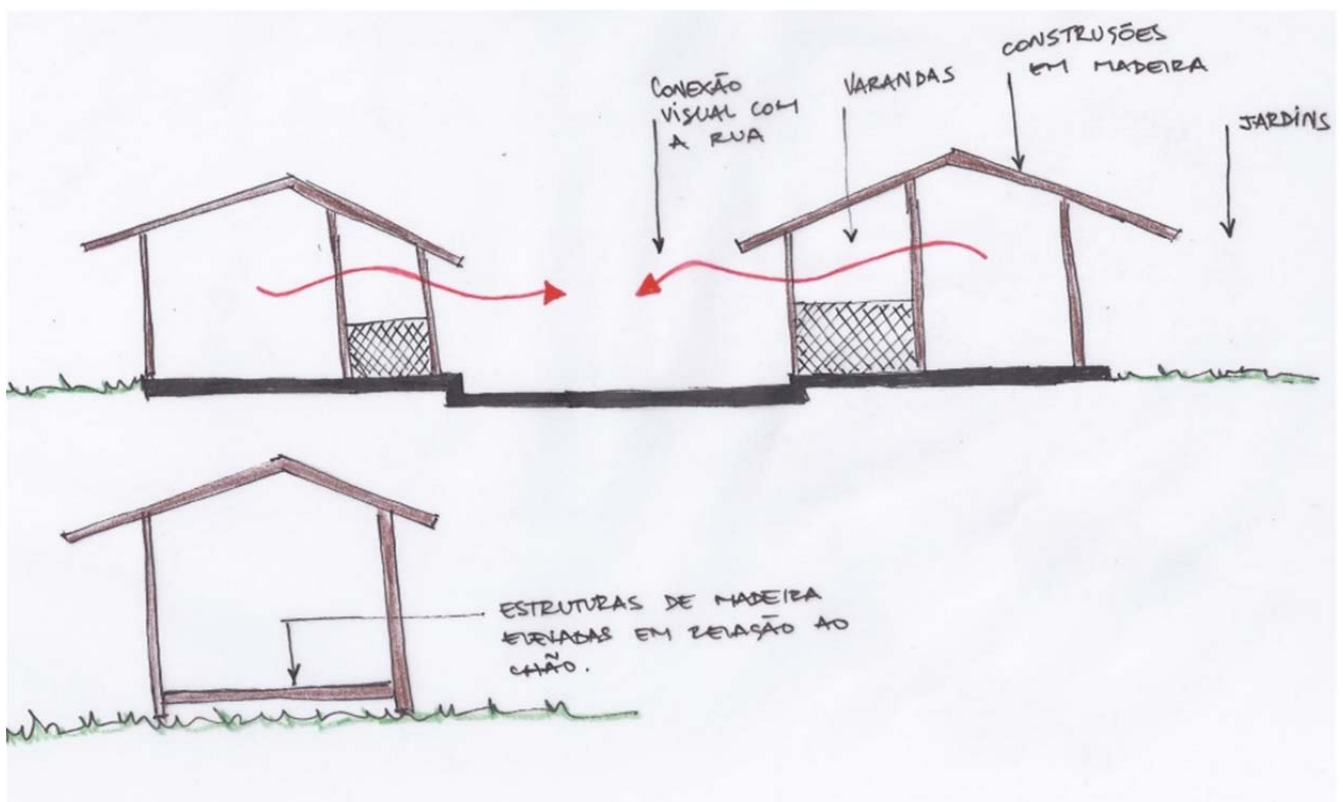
Tipologia arquitetônica das casas originais da Vila Planalto
